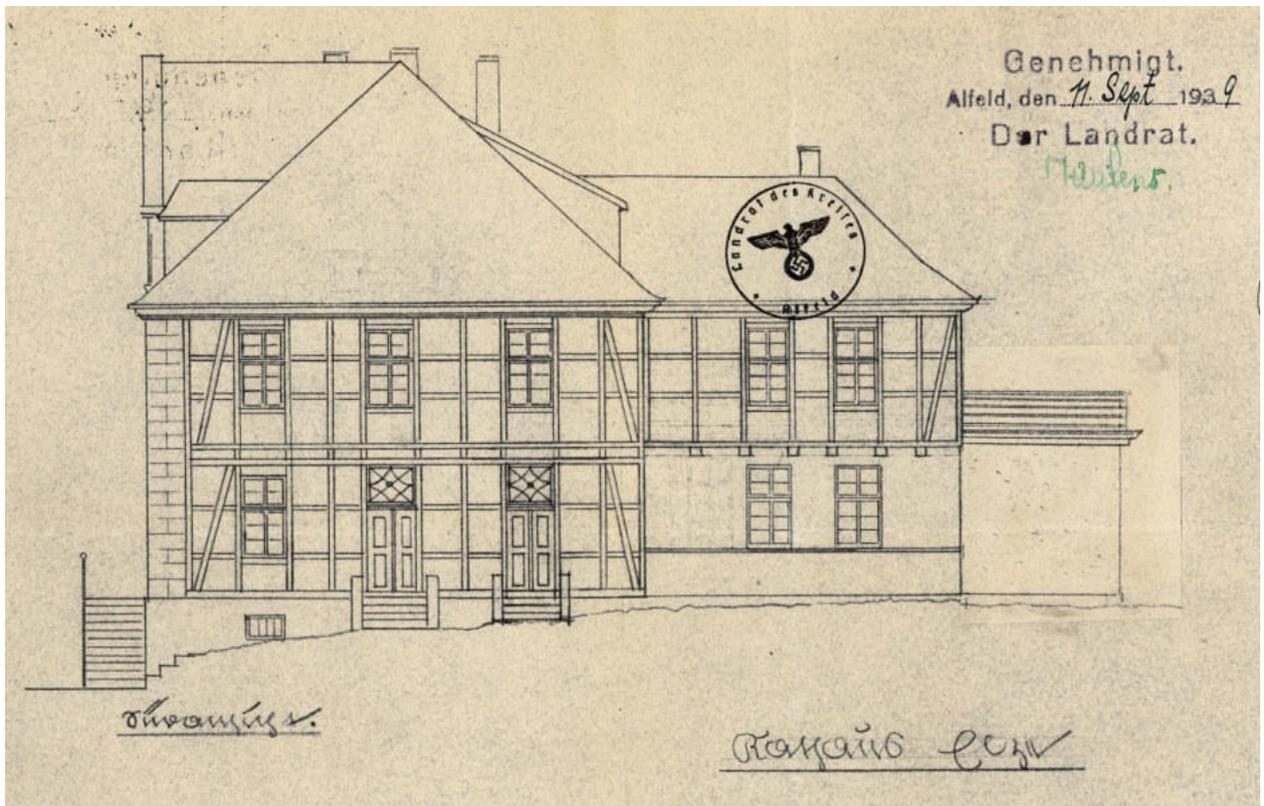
Wie vor, Fachwerk-Südfassade mit zwei Eingängen sowie erster Anbau (mit Fachwerkobergeschoss) und nicht ausgeführter Erweiterung mit Balkon (rechts).
